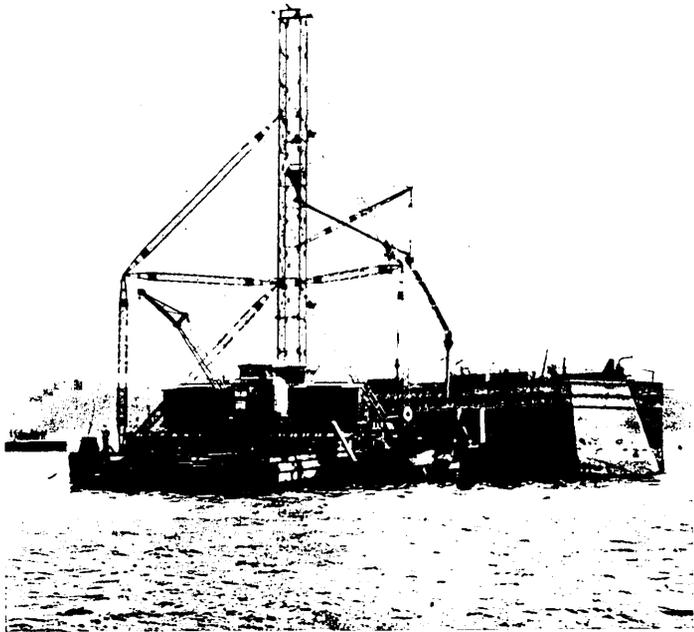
Schwimmende Betonierungsanlage zum Aufbau der Pfeiler.
